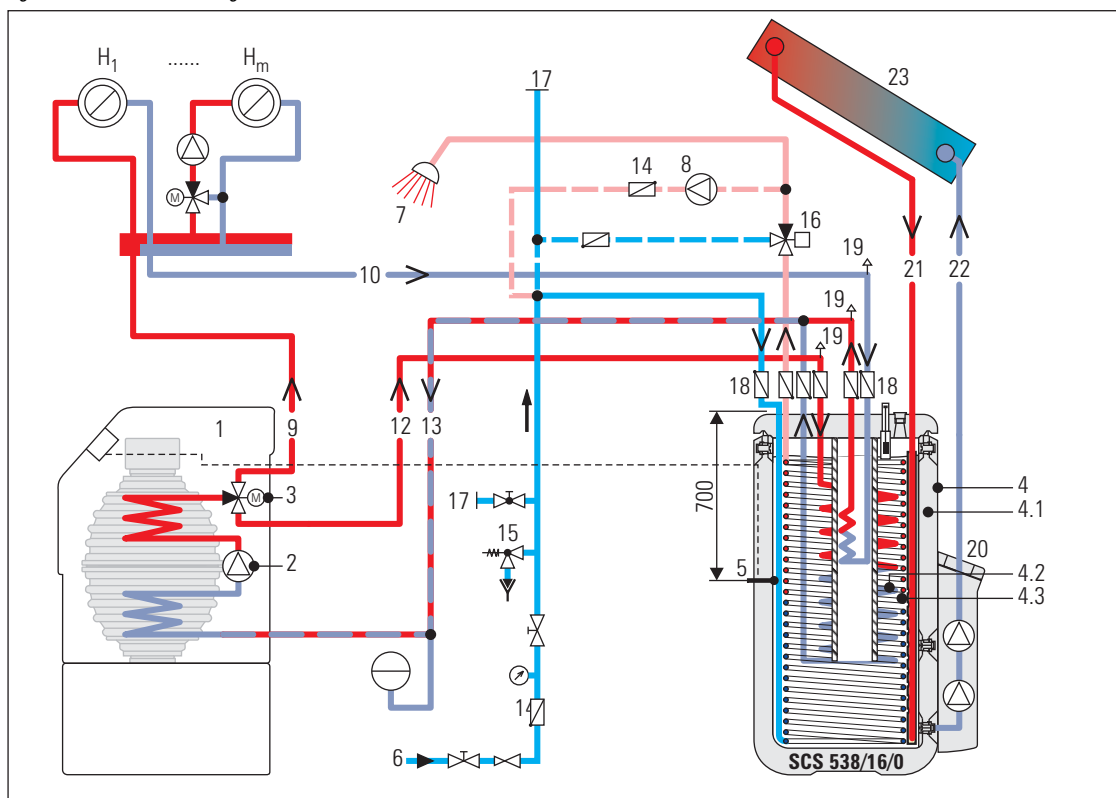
Schema di collegamento standard ROTEX Sanicube Solaris¹⁾
